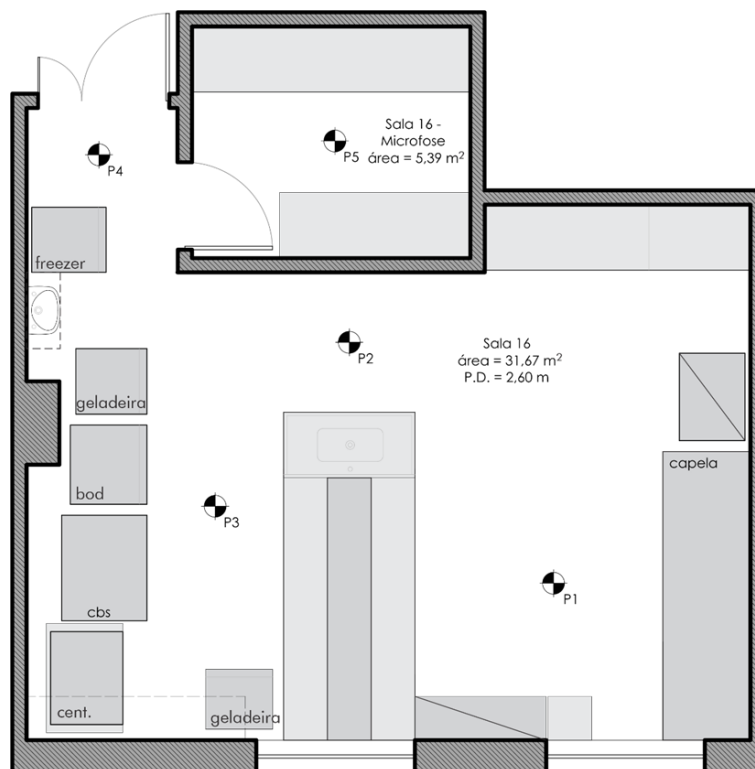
Planta esquemática dos pontos de medição da sala 16, Pav. Cardoso Fontes. Sem escala.
